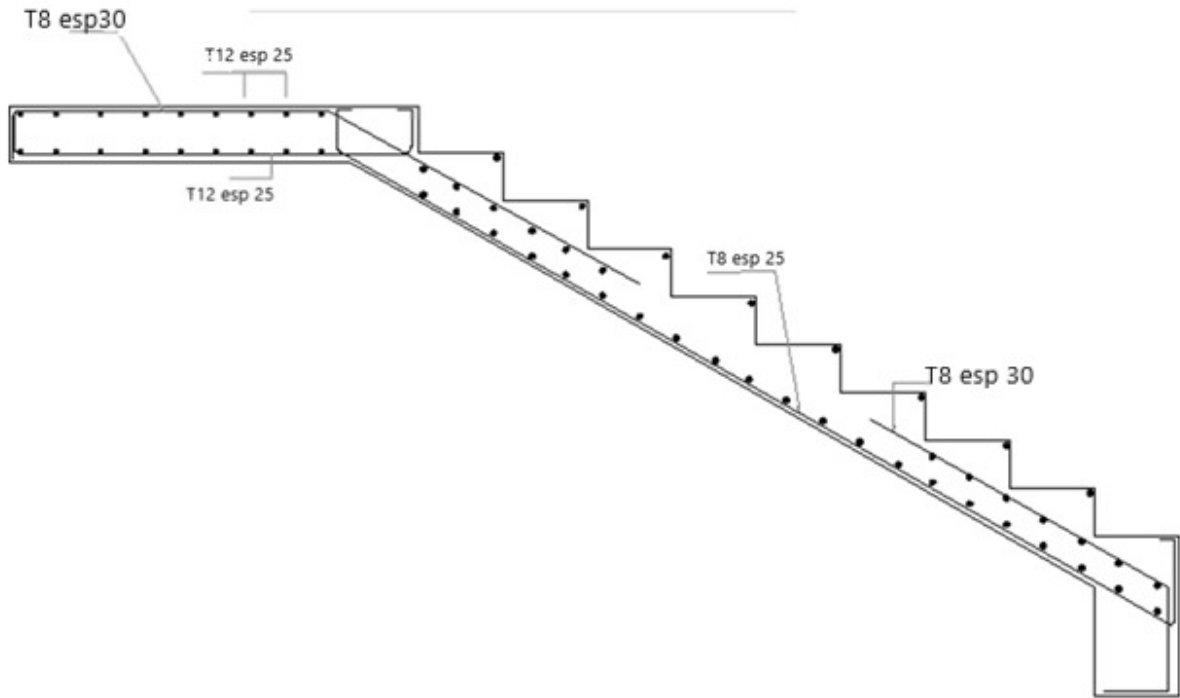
Ferrailage de l'Escalier (Volée 1 -étage courant-)
